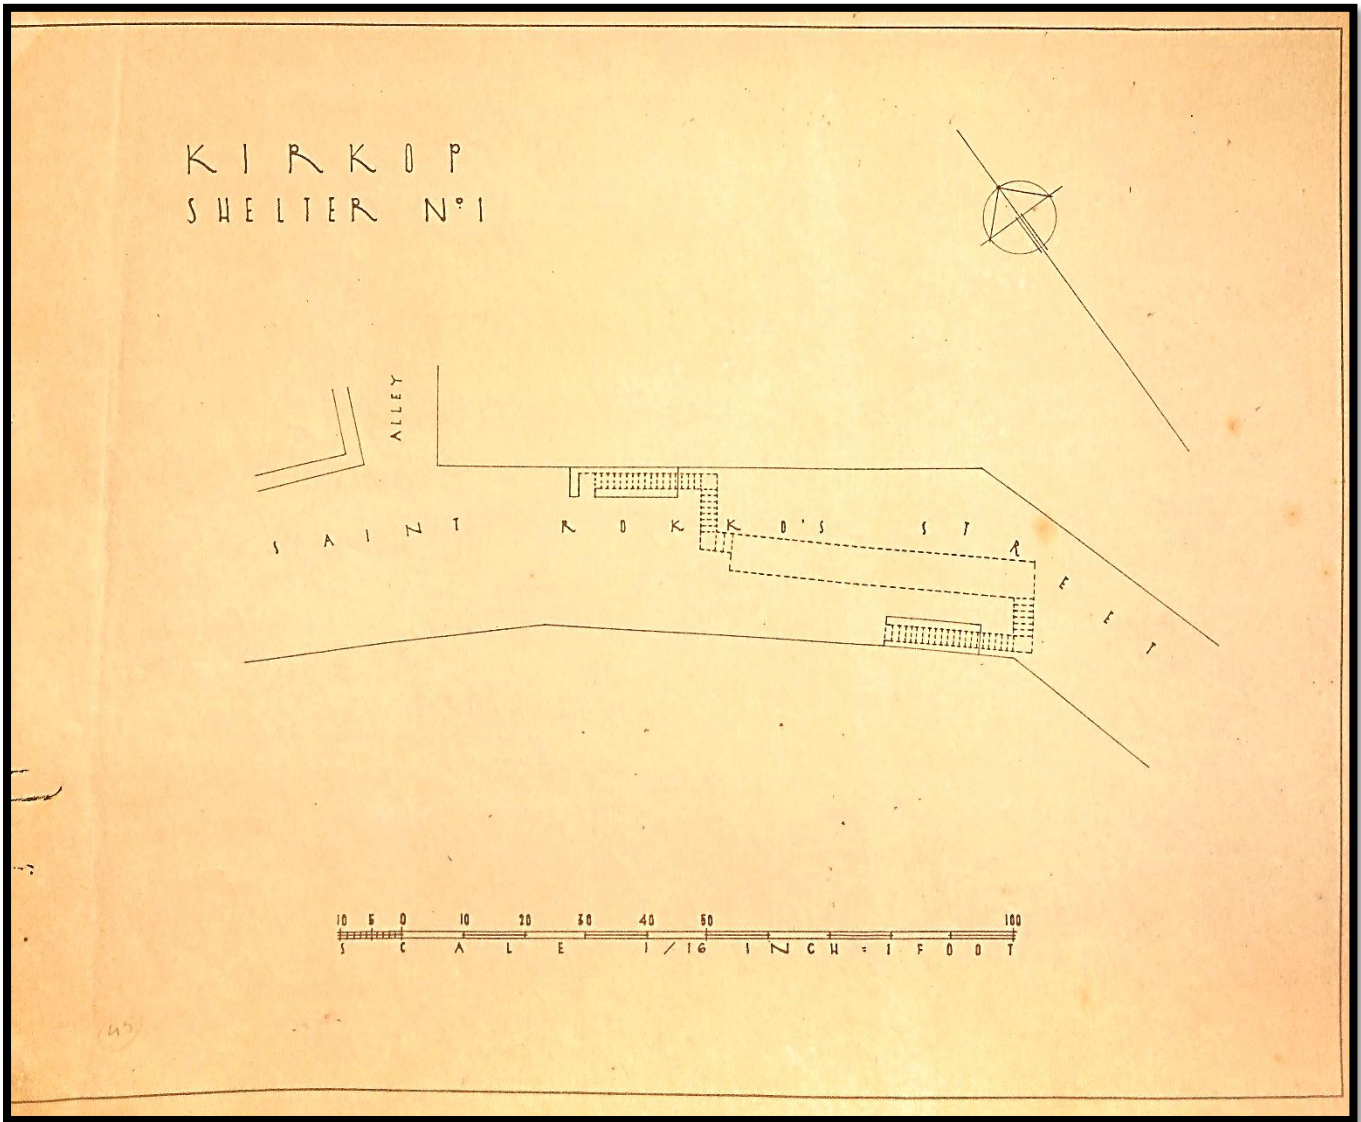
Planta do Abrigo nº1 "Alley – Saint Rokko's Street."
